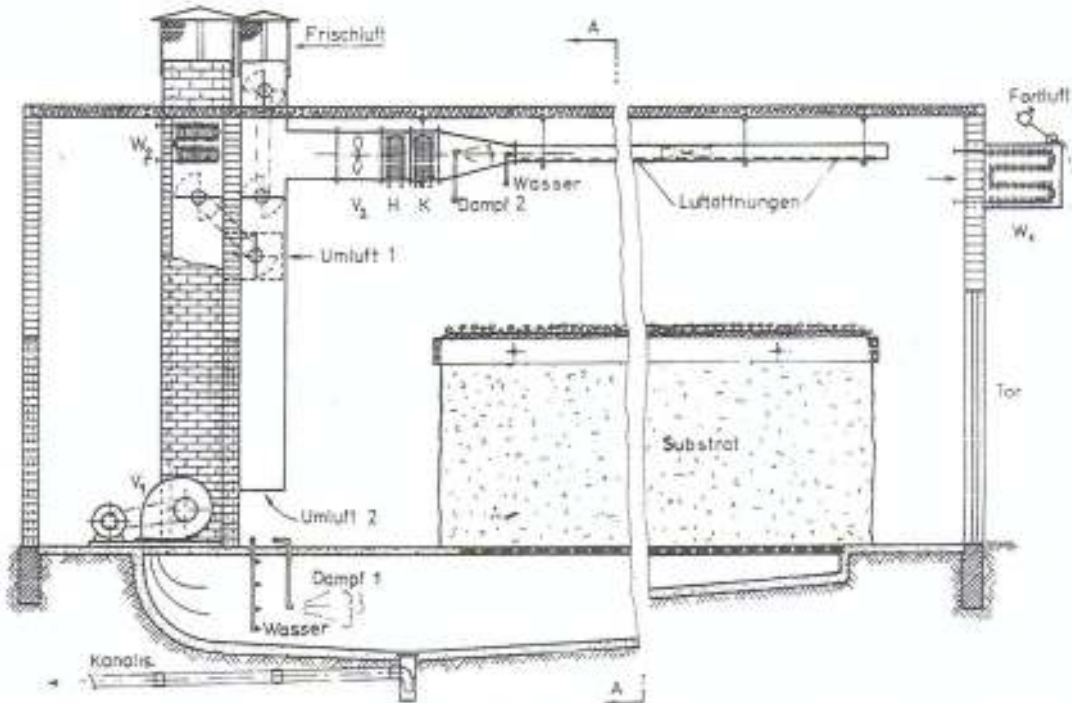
Längsschnitt durch das Betriebsgebäude. V_1 = Radialventilator für Pasteurisierung, V_2 = Axialventilator für Raumbelüftung, H und K = Register für Heizung und Kühlung, W_1 und W_2 = Wärmeaustauscher
